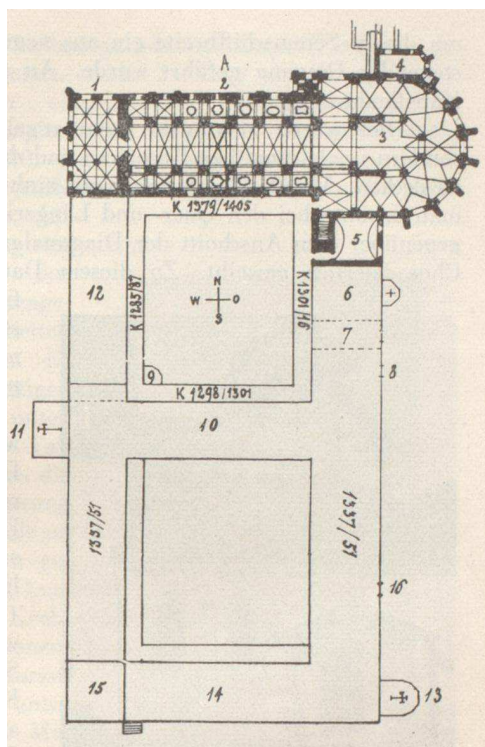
Stift Baumgartenberg, Grundriss von Hans Heinrich Blumenthal, 1949.
